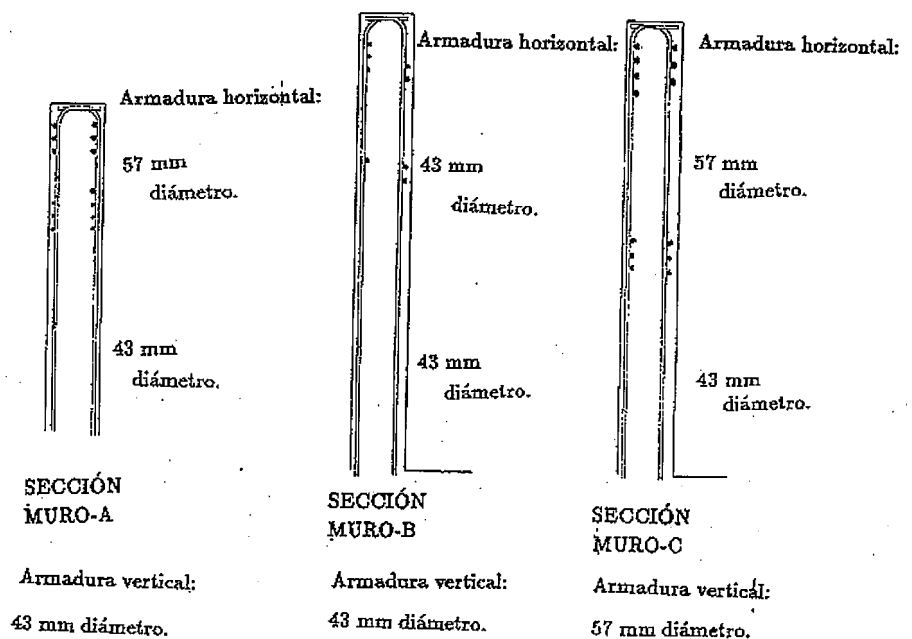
Detalle de una sección vertical de los tres muros biológicos afectados. Posición interior de las armaduras y diámetro de las mismas.
